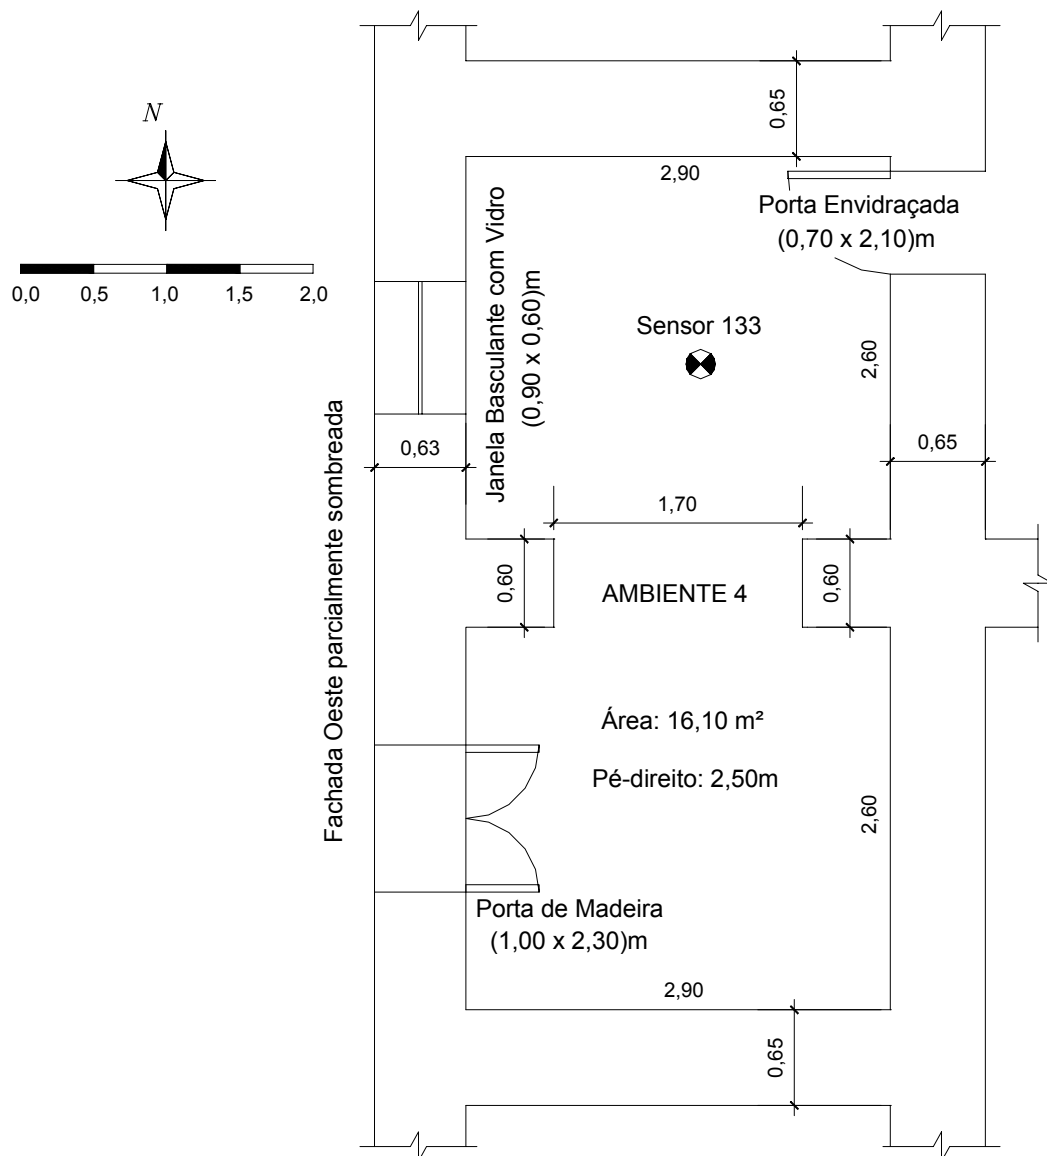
Planta baixa do ambiente monitorado - Edificação 4.
